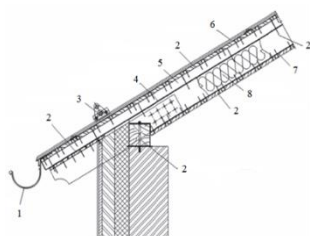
Слои скатной крыши [1]: 1 – водосточный желоб, 2 – несущие конструкции, 3 – снегозадержание, 4 – диффузионный слой, 5 – вентиляционный слой, 6 – гидроизоляция, 7 – пароизоляция, 8 – теплоизоляция
